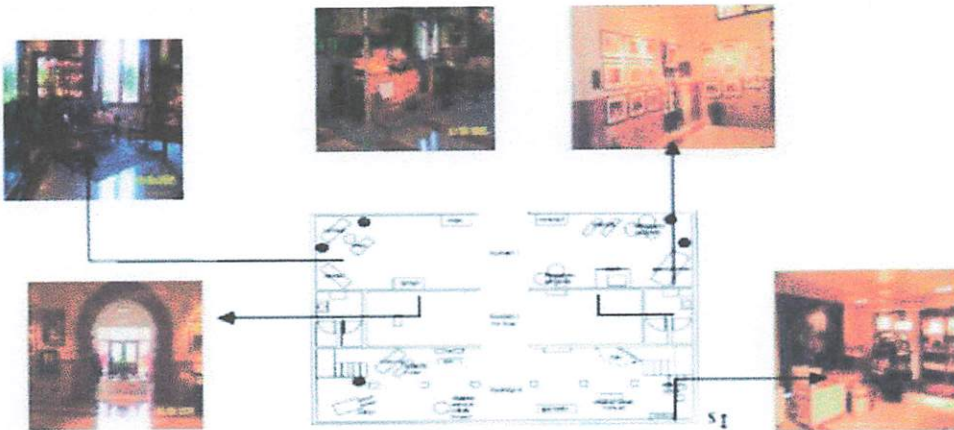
Denah dan Lantai Museum Lantai 1.
